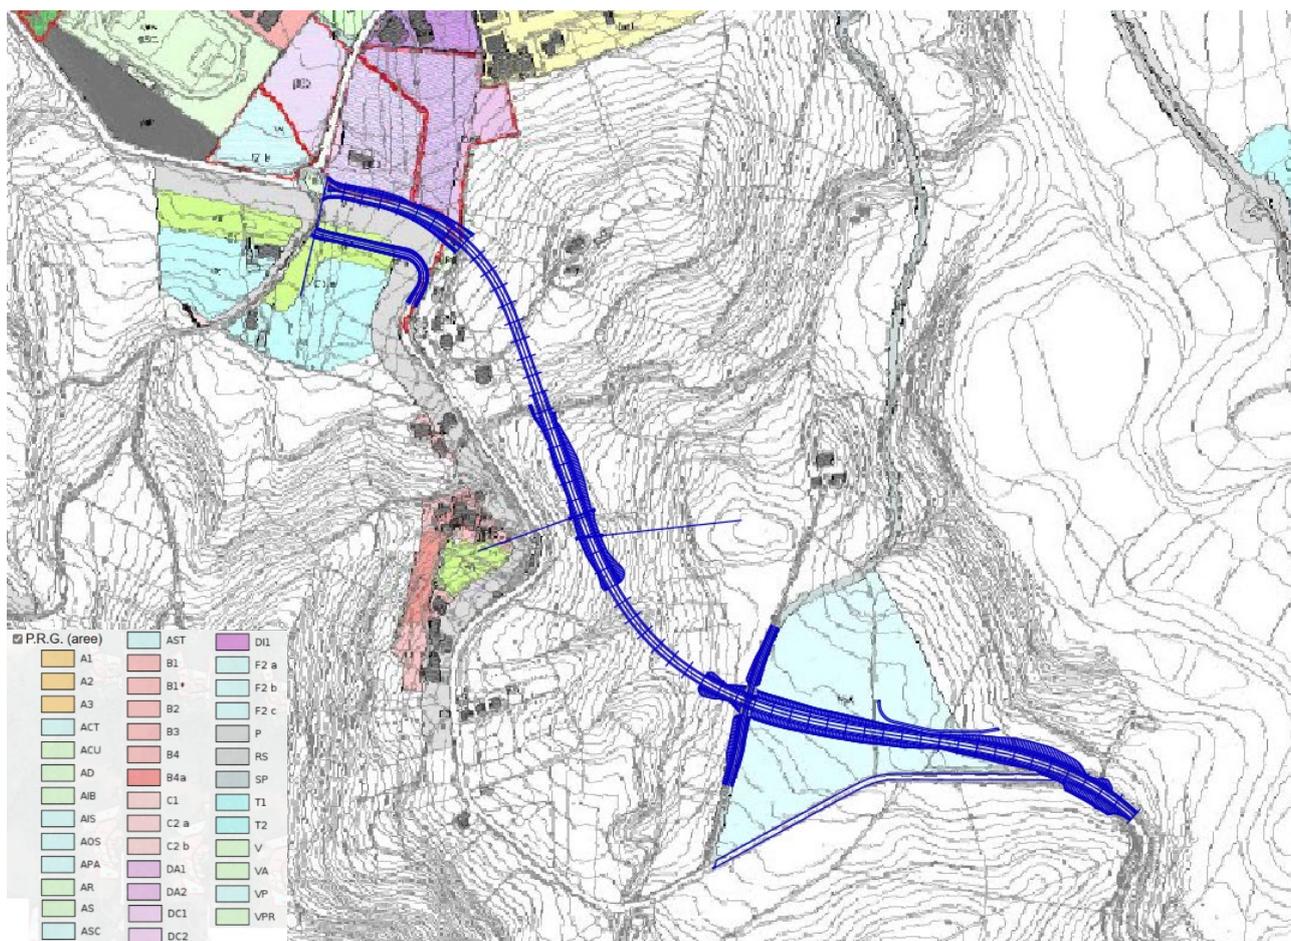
Stralcio planimetrico della TAV. C3.4
